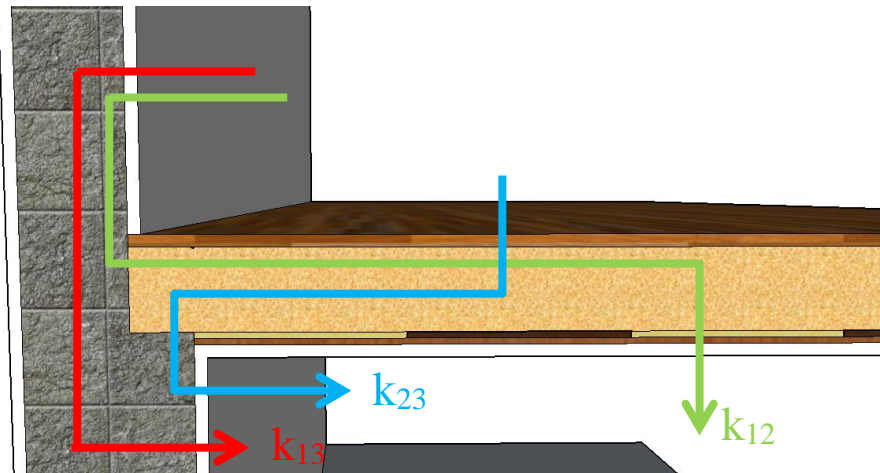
Pormenor construtivo da ligação entre a parede de meação e o pavimento
